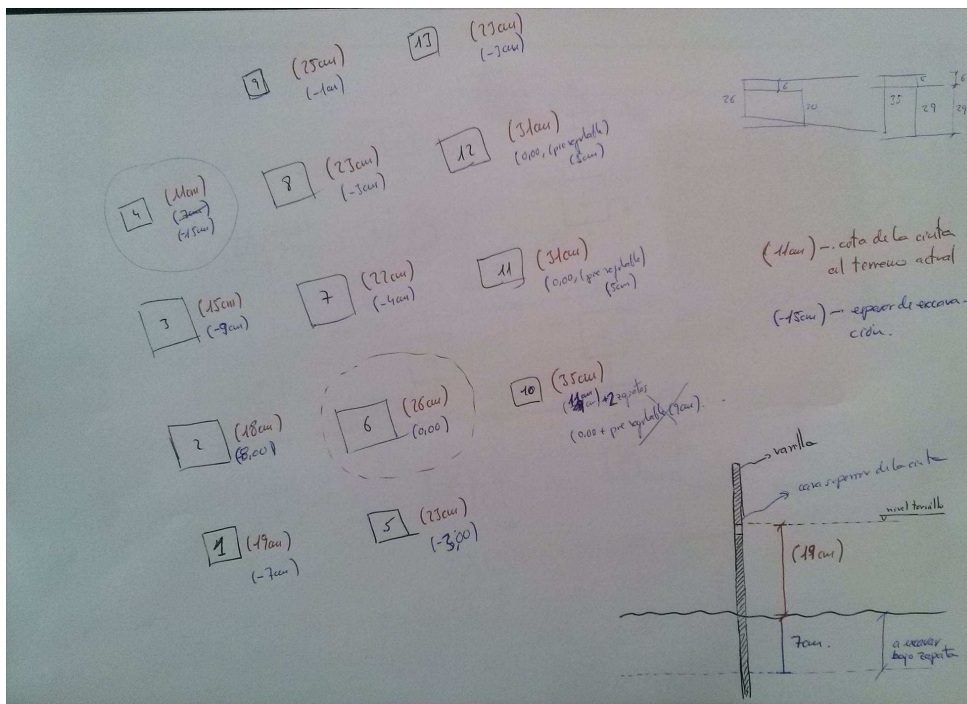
Plano de excavación y cota de apoyo de las zapatas prefabricadas / [EP]
